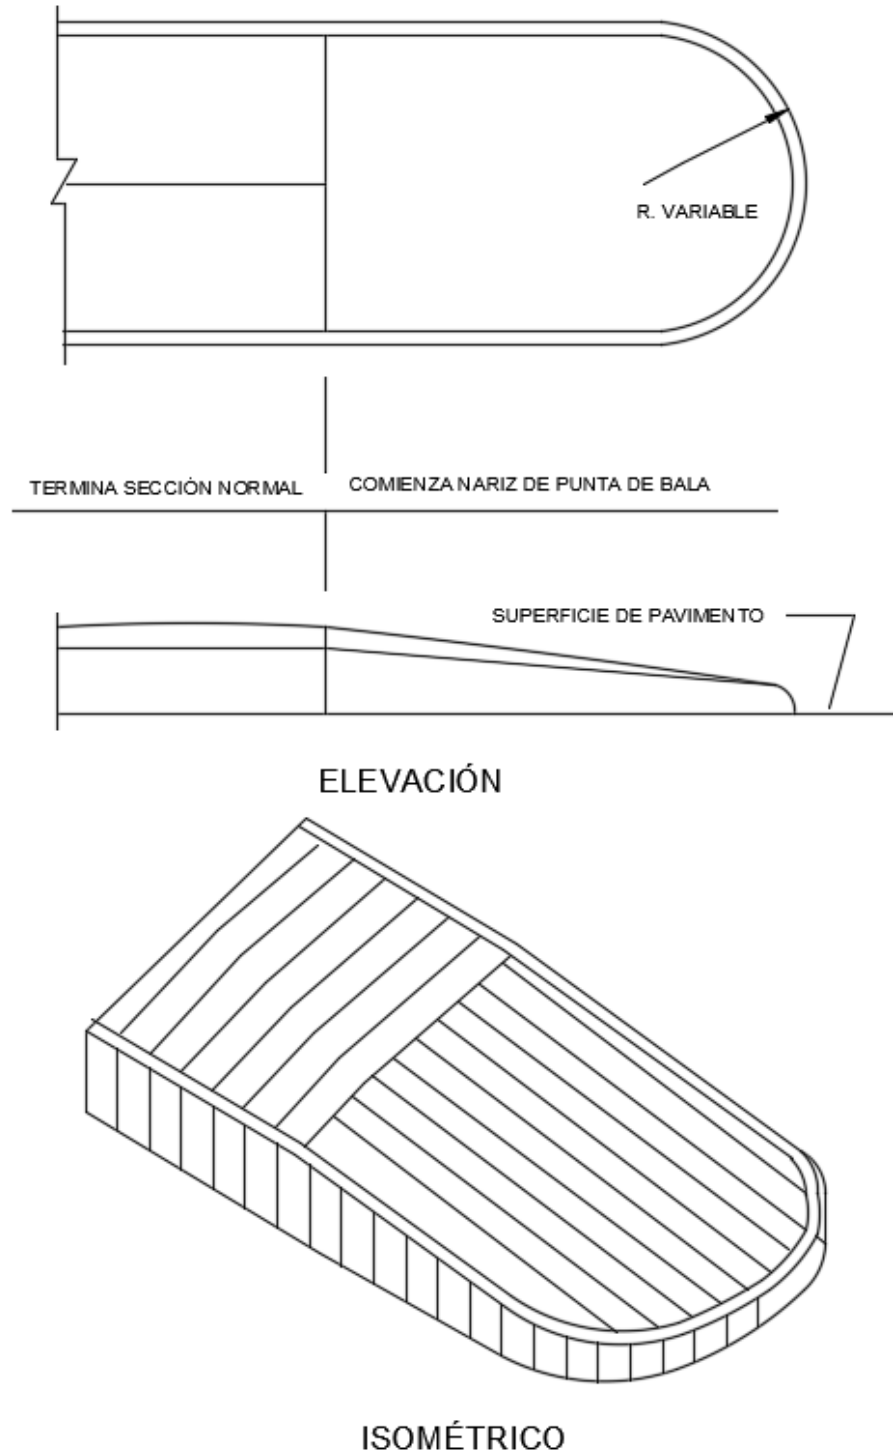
Inclinación de la nariz en el extremo de entrada de la faja separadora central o de la isleta en esquina
